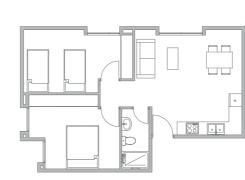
Planta Departamento Tipo C, Anteproyecto Fuente: Autores, 2022
